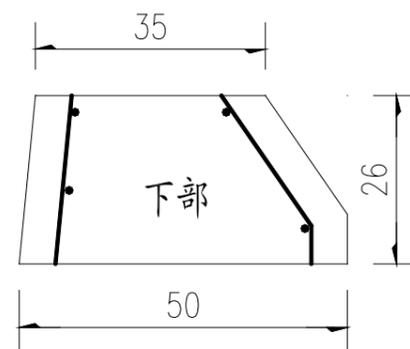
护栏下部 M_{w3} 计算简图 (尺寸单位: cm)
